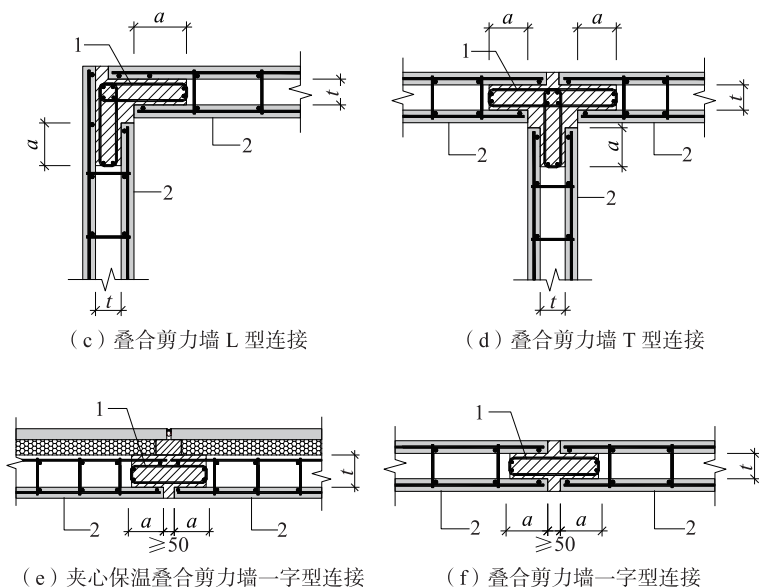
叠合剪力墙竖向接缝成型钢筋笼连接构造
